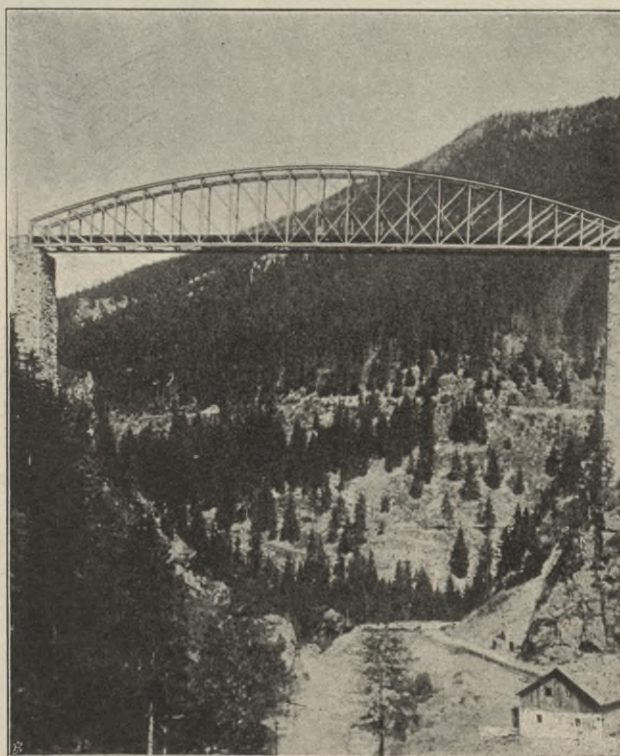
Halbparabelträger mit über 2 Feldern reichenden Diagonalen (Trisana Thalbrücke der Arlbergbahn bei Innsbruck 120 m St. W. 1882—84 erbaut.
